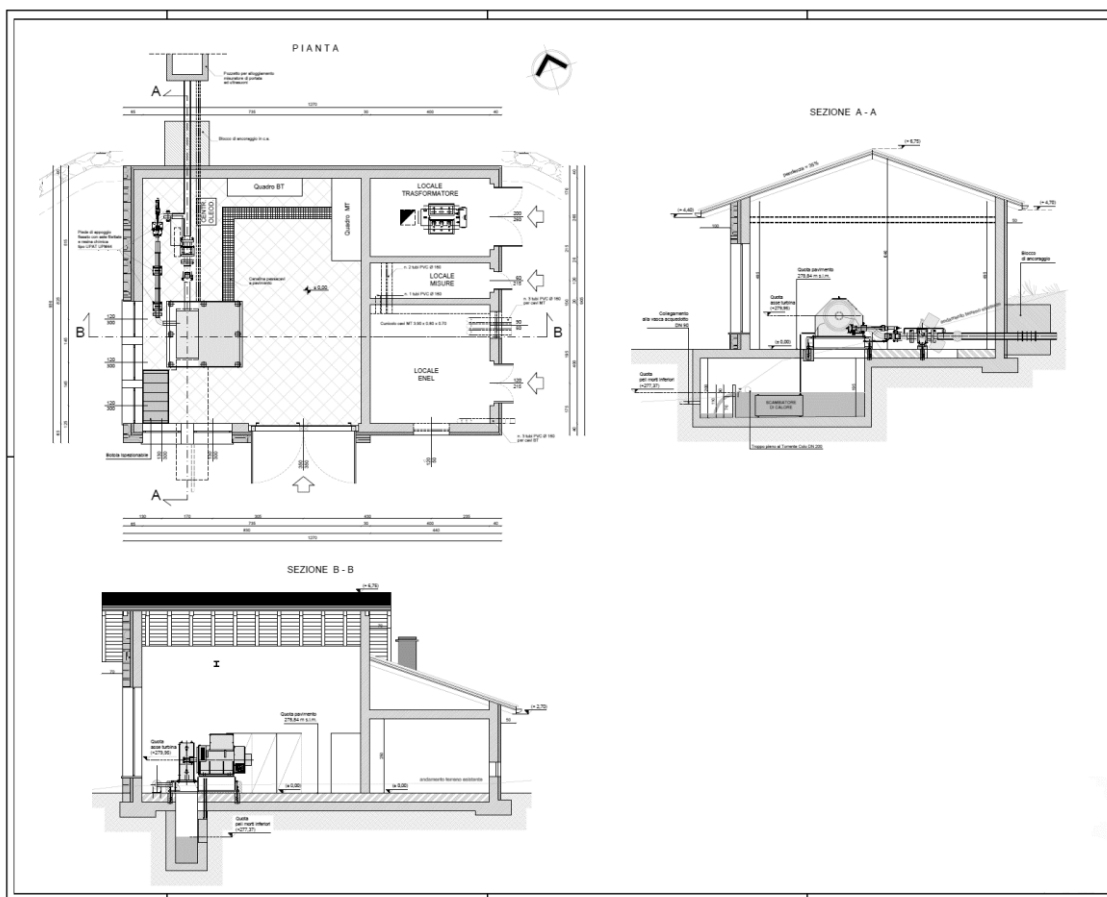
Pianta e sezioni dell'edificio di centrale dell'impianto di Piantedo
